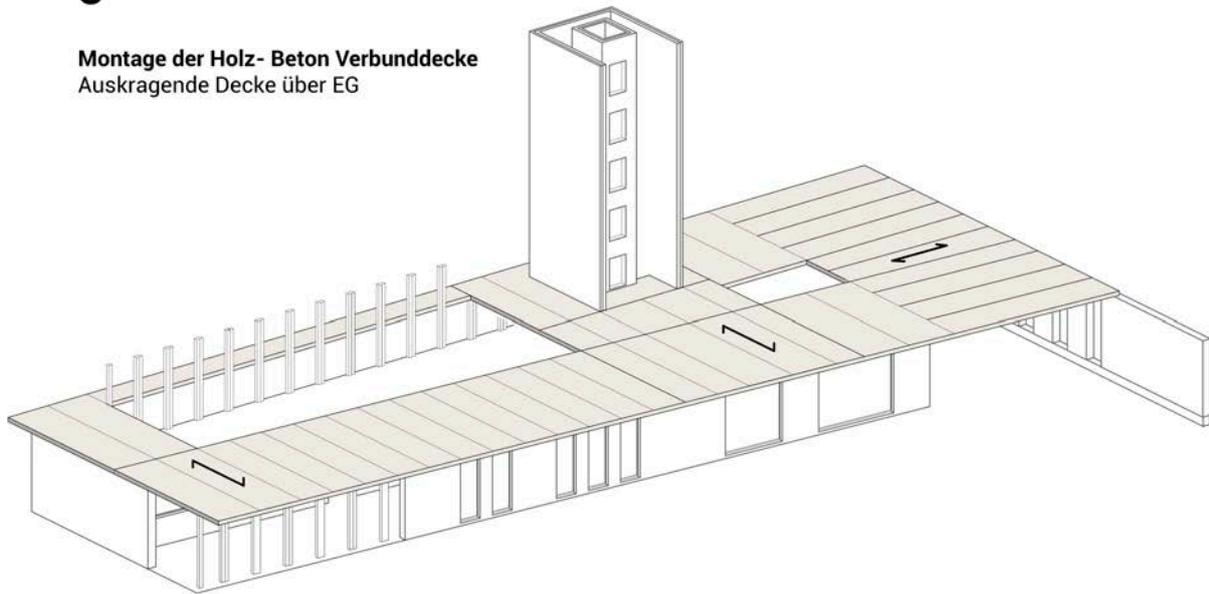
Montage der vorgefertigten, auskragenden Holz- Beton- Verbunddecke über dem Erdgeschoß; © Bernhard Bauer
